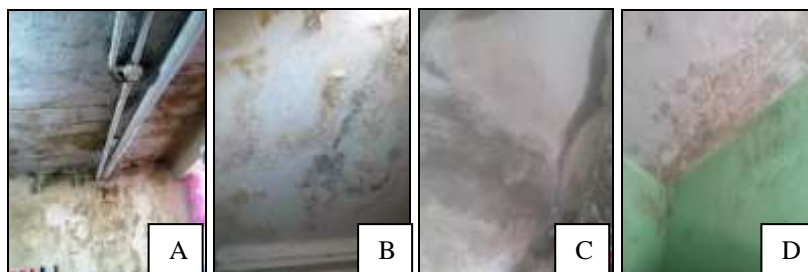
Manchas causadas pela falta de impermeabilização nas lajes das edificações: (A) Garagem da Edificação 1; (B) Laje da suíte 4 da Edificação 2; (C) Laje da garagem da Edificação 3; (D) Laje da suíte 2 da Edificação 4
